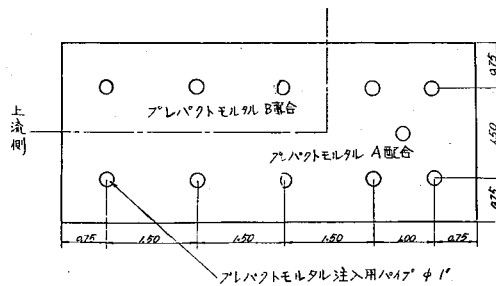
篠津運河頭首工プレバクトコンクリート試験工事設計図 (単位 m)
